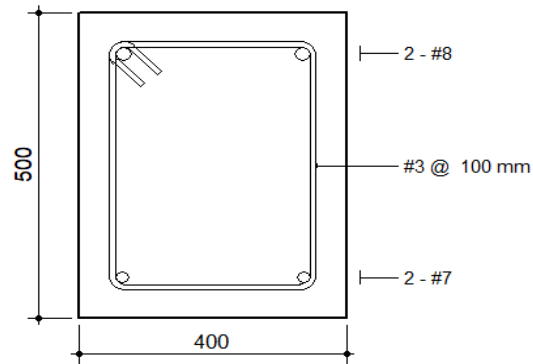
Sección de viga interior plantas 5 y 6. Fuente: Propia.
